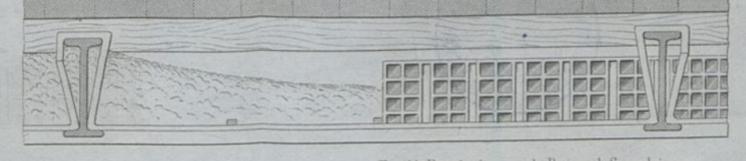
Fussboden nach Roussel, Grundriss.
